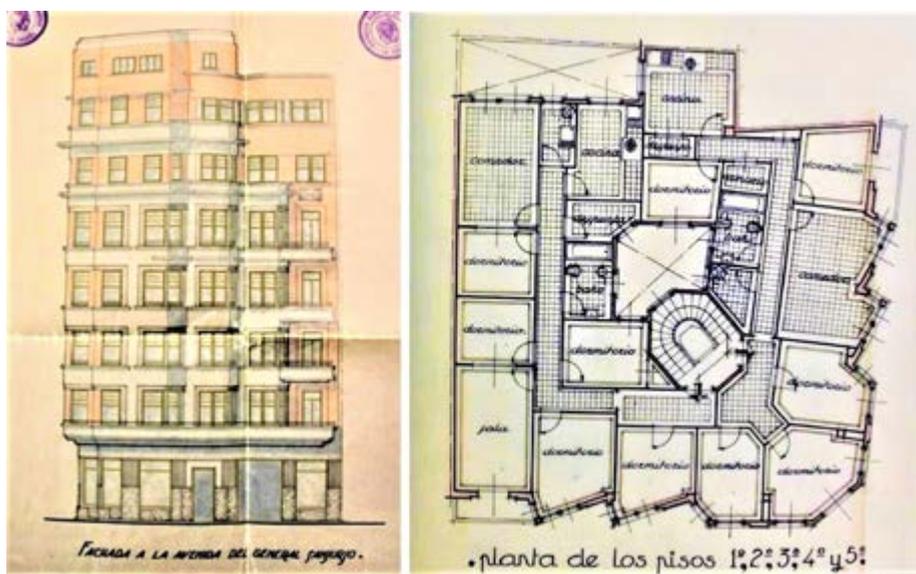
Alzado y planta del proyecto de viviendas en Avda. de Oza 8, del estudio Tenreiro y Estellés. (A.H.M.C.).
